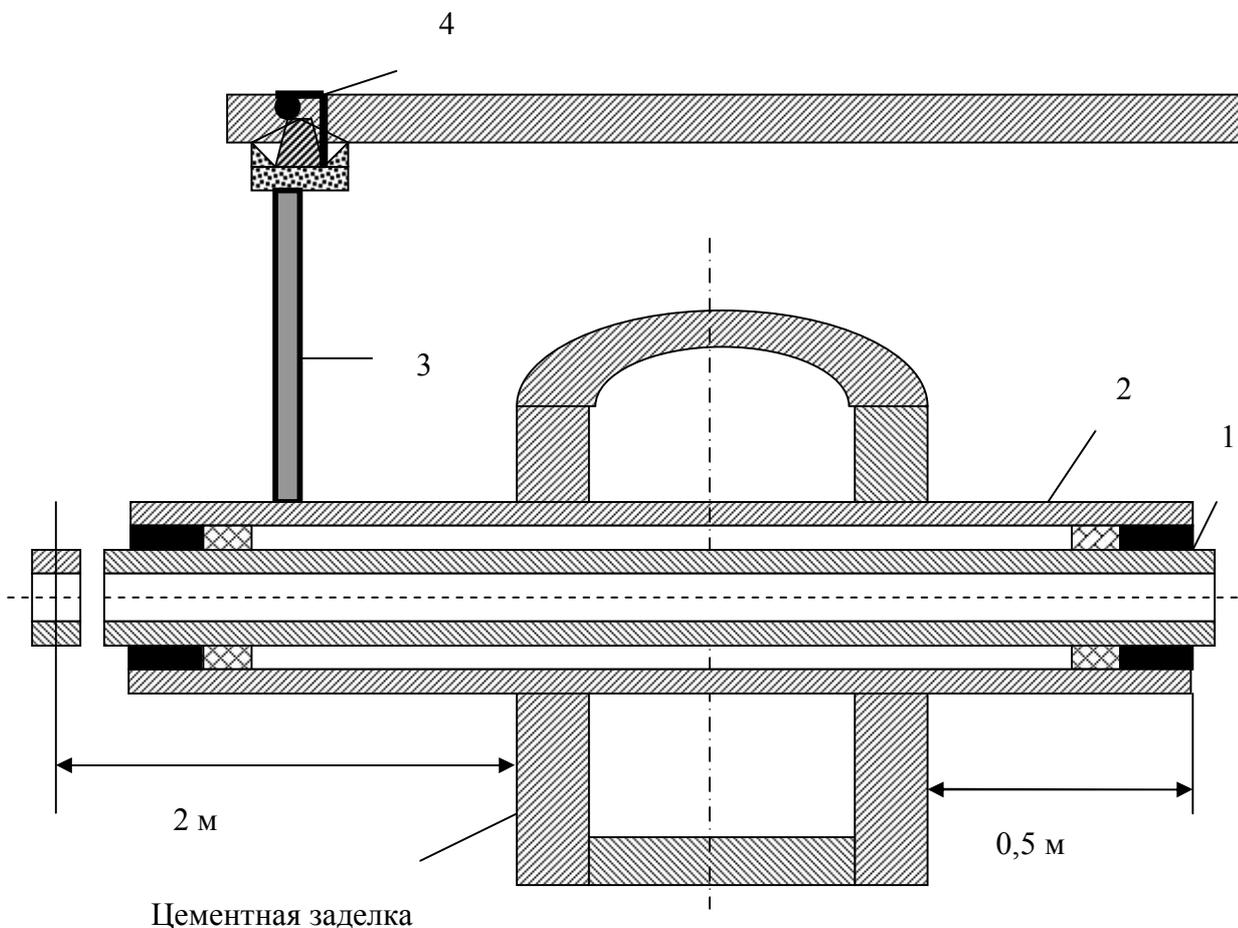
Схема пересечения газопроводом коллектора или колодца:
